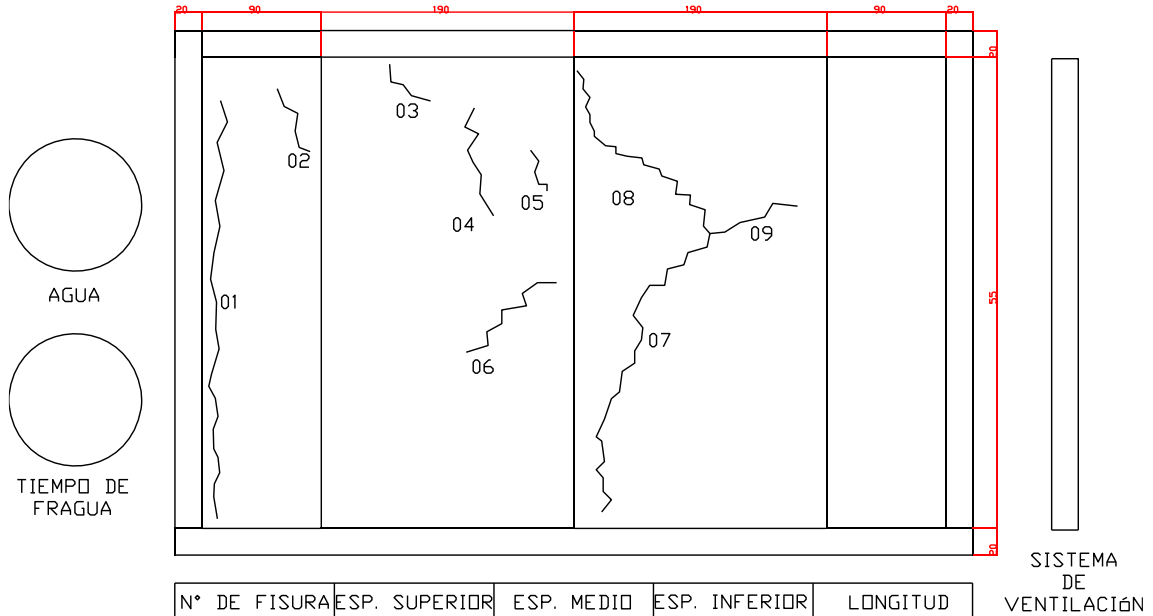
Identificación de las primeras fisuras después de las 6 horas de vaciado.
